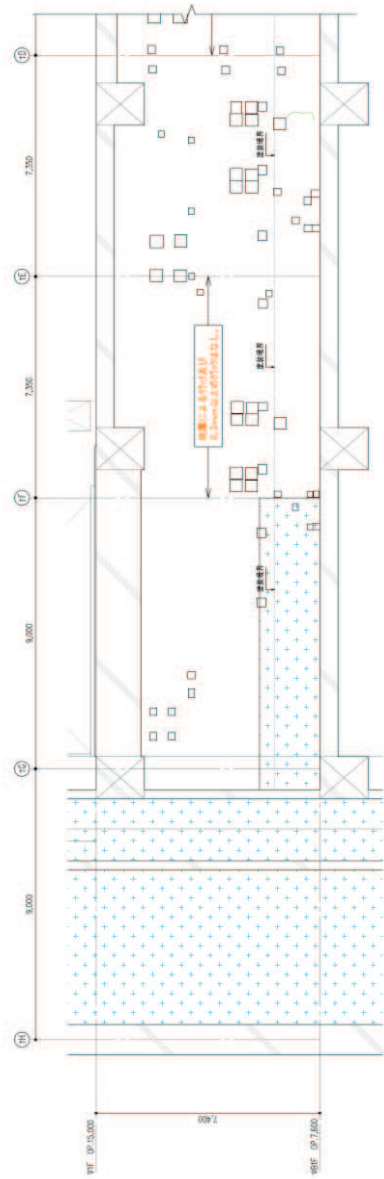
タービン建屋のひび割れ分布 耐震壁 (16) 地下 2 階 TH 通り
